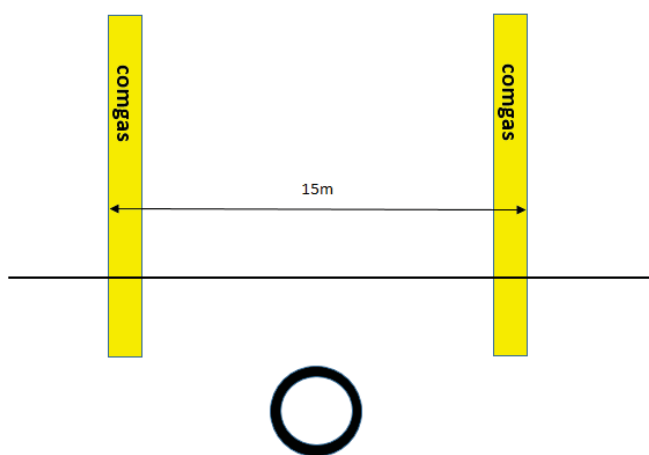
Arranjo Típico da Implantação do Gasoduto Terrestre e Faixa de Servidão na Fase de Implantação
